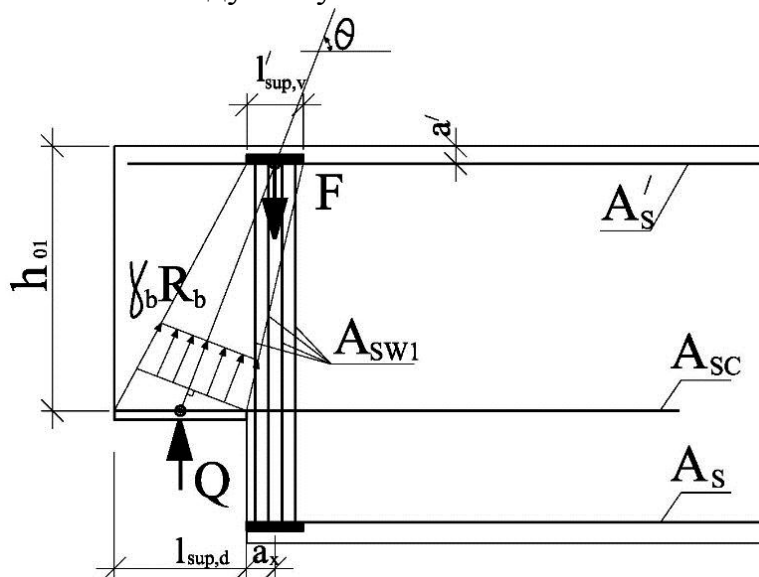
Усовершенствованная стержневая модель сжатой полосы бетона короткой консоли балки
